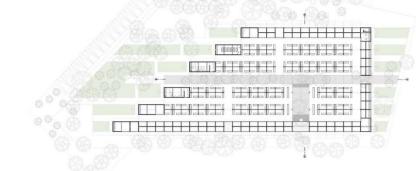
Vista en Planta Mercado Guadalupe México https://www.archdaily.com/996481/ guadalupe-market-colectivoc733?ad_medium=gallery
